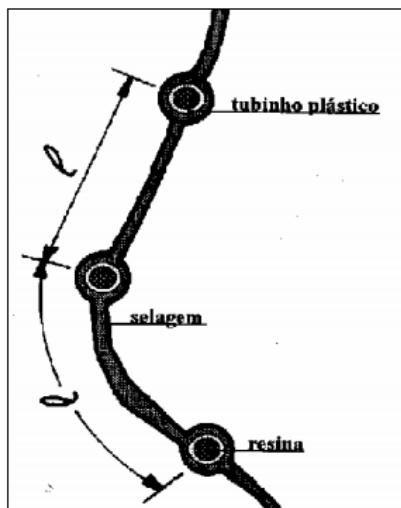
Preparação da fenda para procedimento de injeção (fonte: dissertação *Técnicas de recuperação e reforço de estruturas de concreto armado*, 2006). [40]
